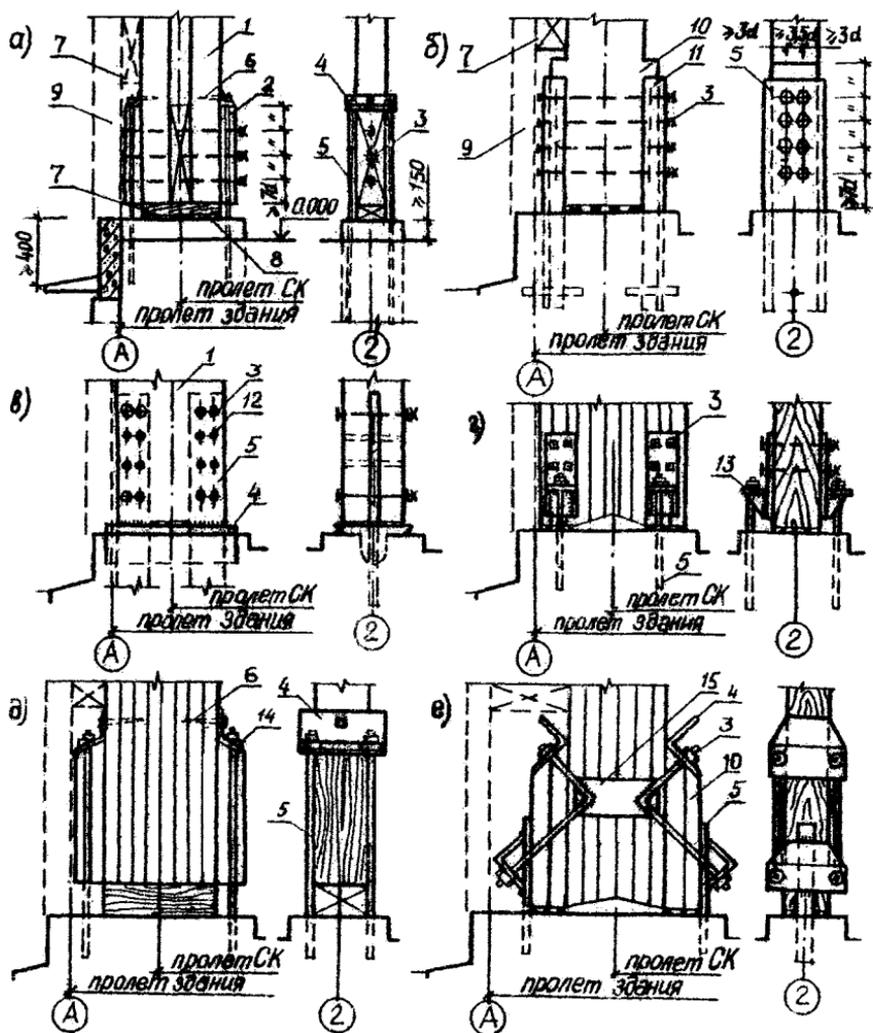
Шарнирные соединения колонн с фундаментом:
